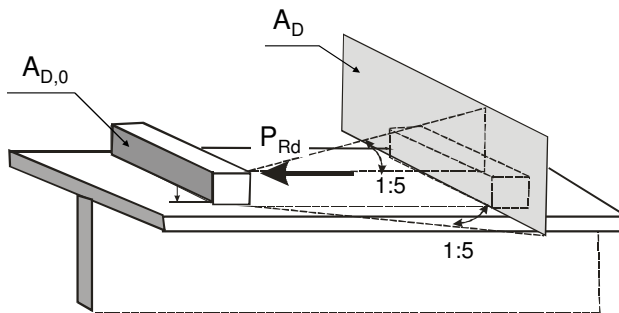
Rechnerische Pressungsfläche bei Blockdübeln
